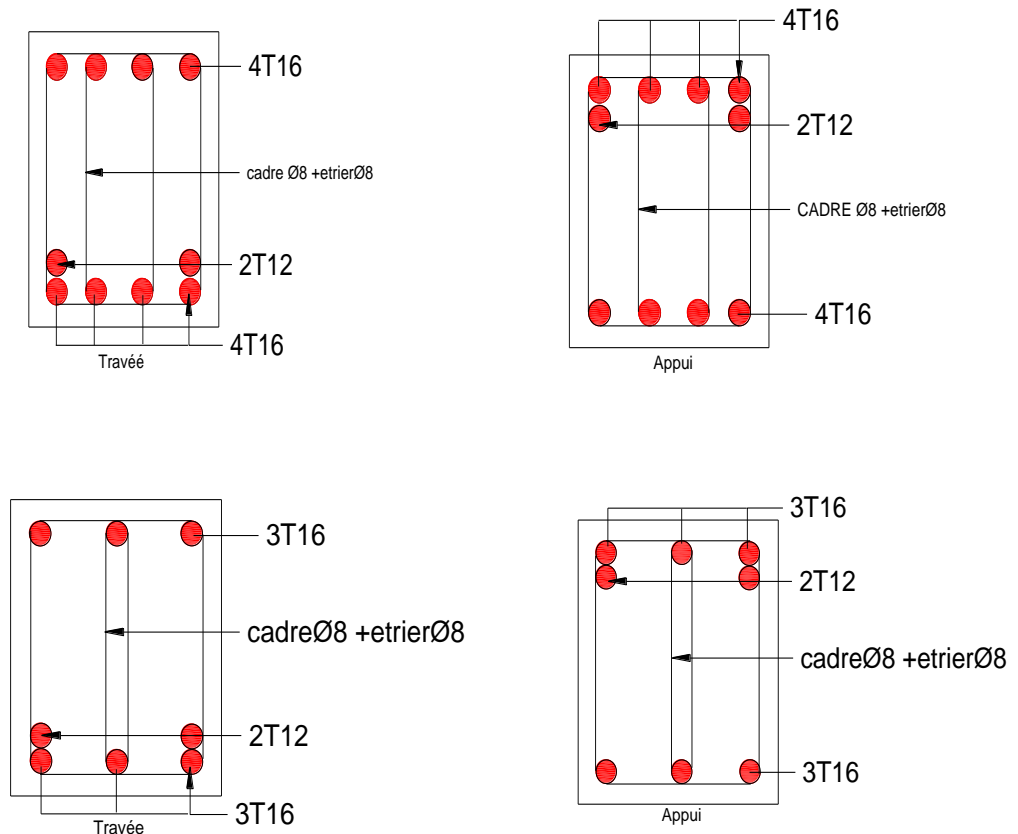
ferrailage de poutre non porteuse RDC et 1<sup>er</sup> et 3<sup>ème</sup> étage
